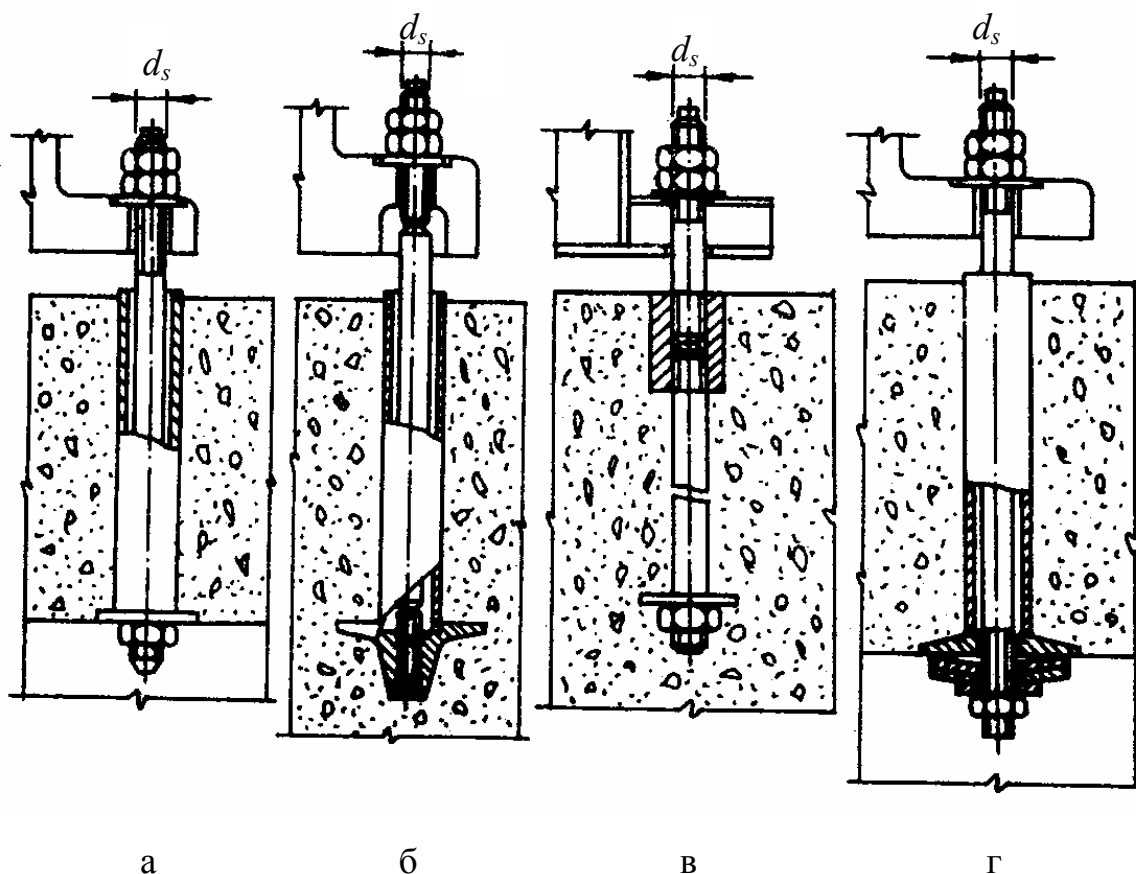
Анкерні болти, встановлювані до бетонування фундаментів:
